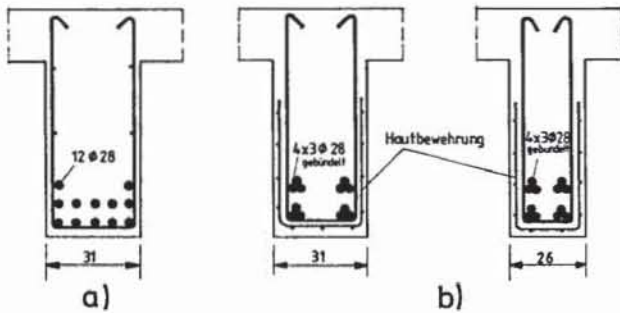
Anordnung der Bewehrung im Querschnitt, a) Einzelstabverlegung, b) Stabbündelung
